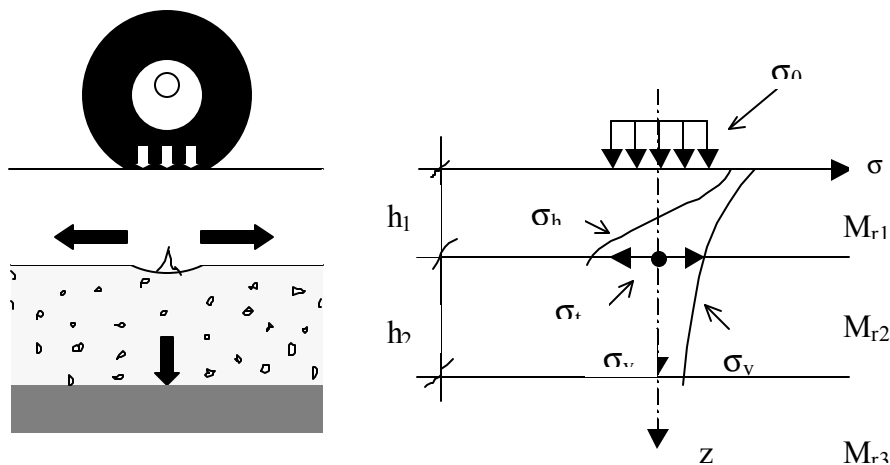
Tensões Normais Verticais e Horizontais num Pavimento (Fonte: Mecânica dos Pavimentos, MEDINA, J., 1997).
